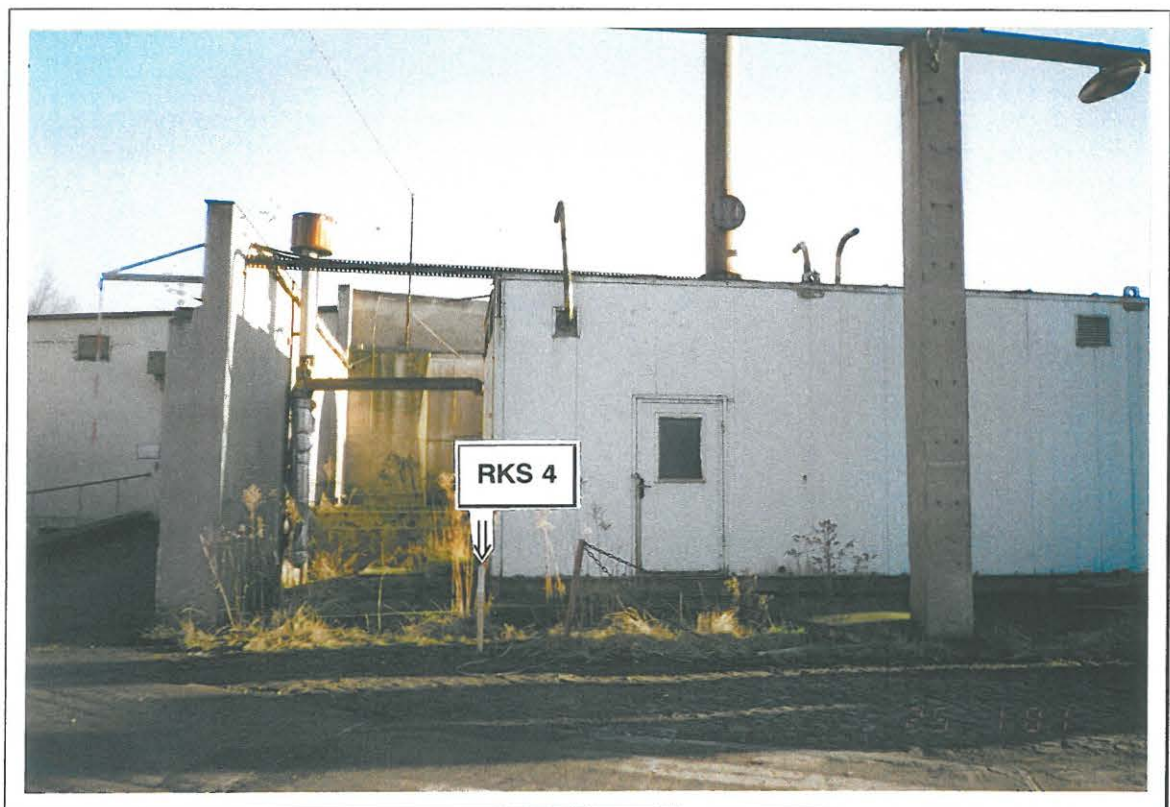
Probenahmepunkt RKS 4 nordwestlich des Schweröllagertanks (im Hintergrund: Öltank mit Betonwanne, im Vordergrund: Heizkesselanlage)
